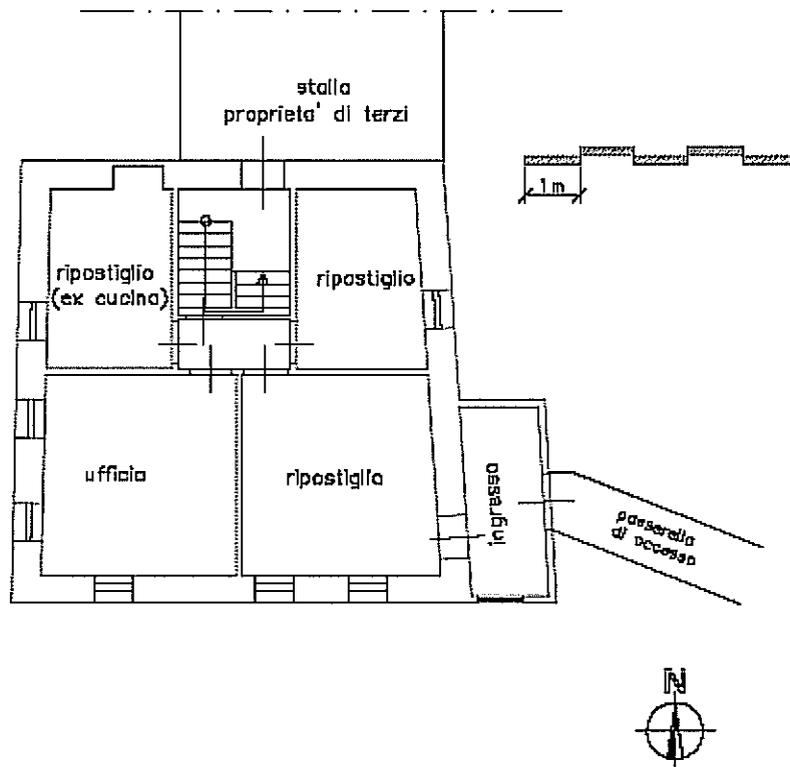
PIANO SECONDO (SOFFITTA)
